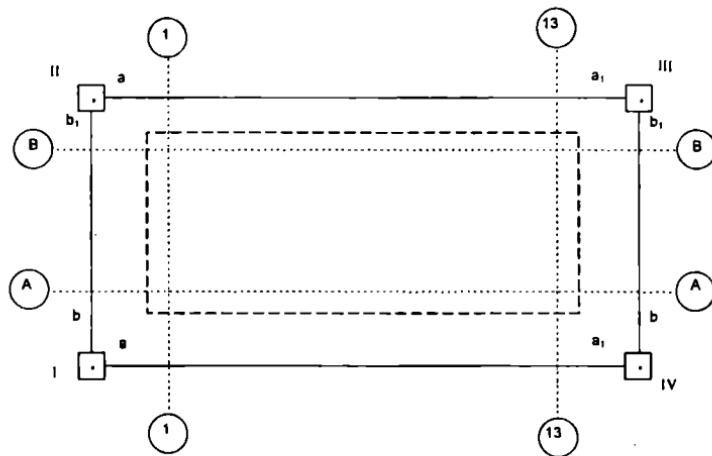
Схема перенесения в натуру осей здания от строительной сетки способом створной засечки
